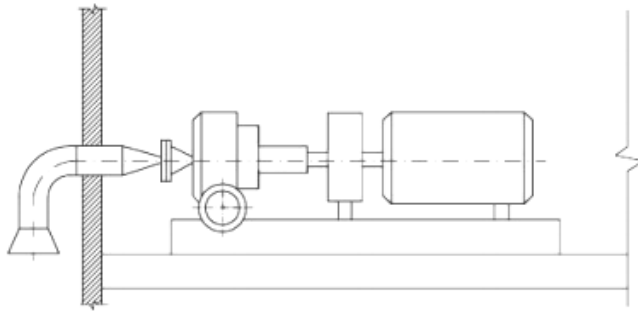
Монтажна схема всмоктувального трубопроводу
